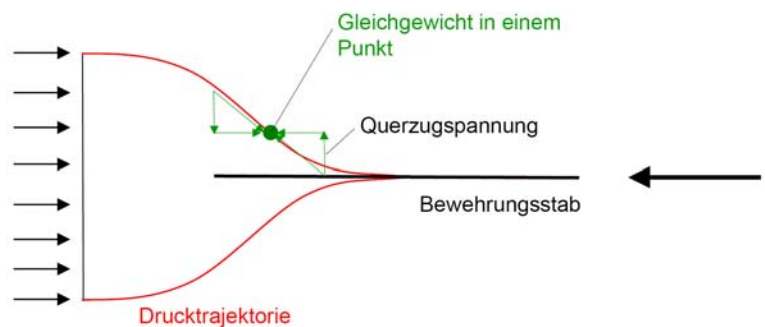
Einleitung von Druckkräften in einen Bewehrungsstab
